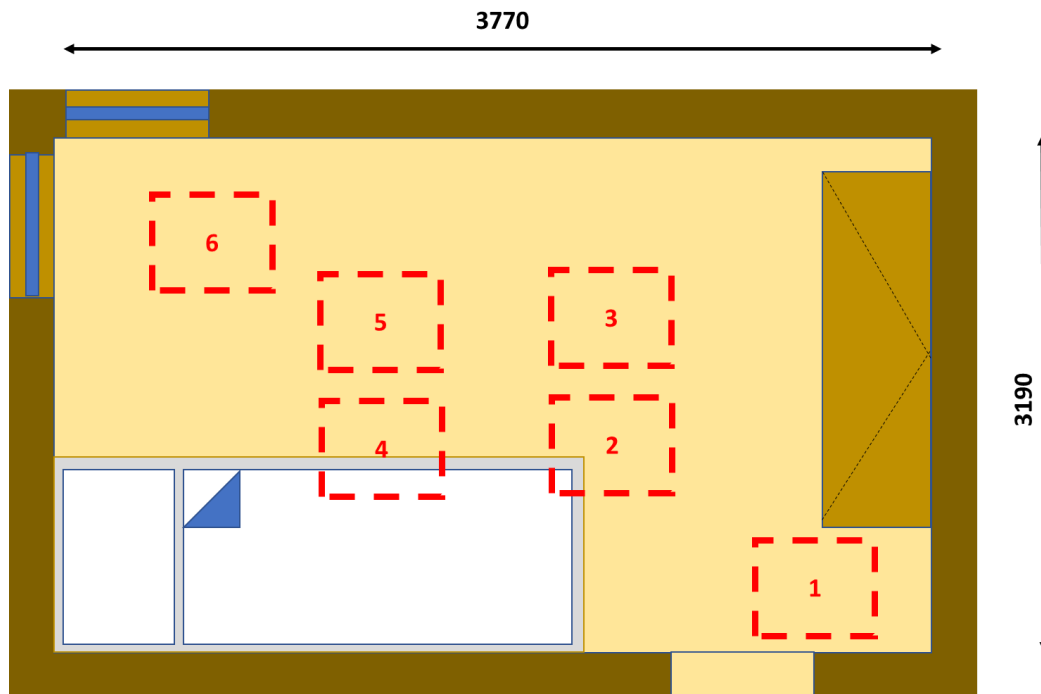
Grundriss der untersuchten Decke mit den Anregungsbereichen
